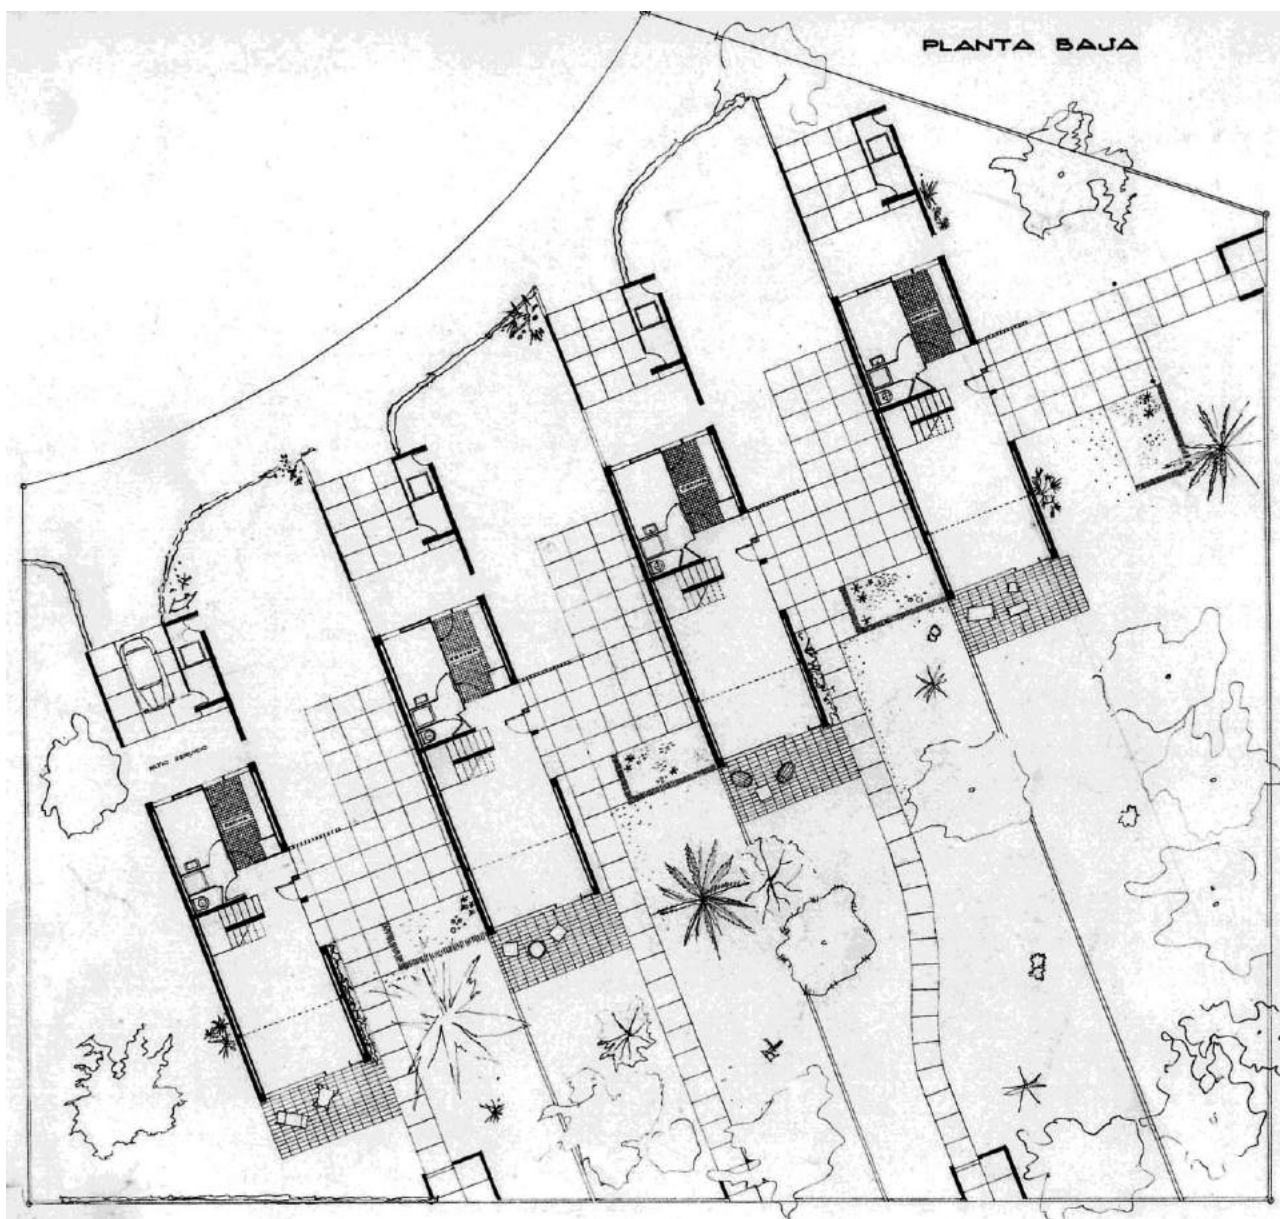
Planta baja del primer anteproyecto para Torredembarra (1955).
